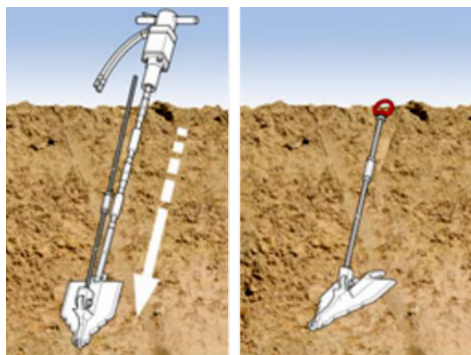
Montaggio e principio di funzionamento di un ancoraggio a piastra basculante.
